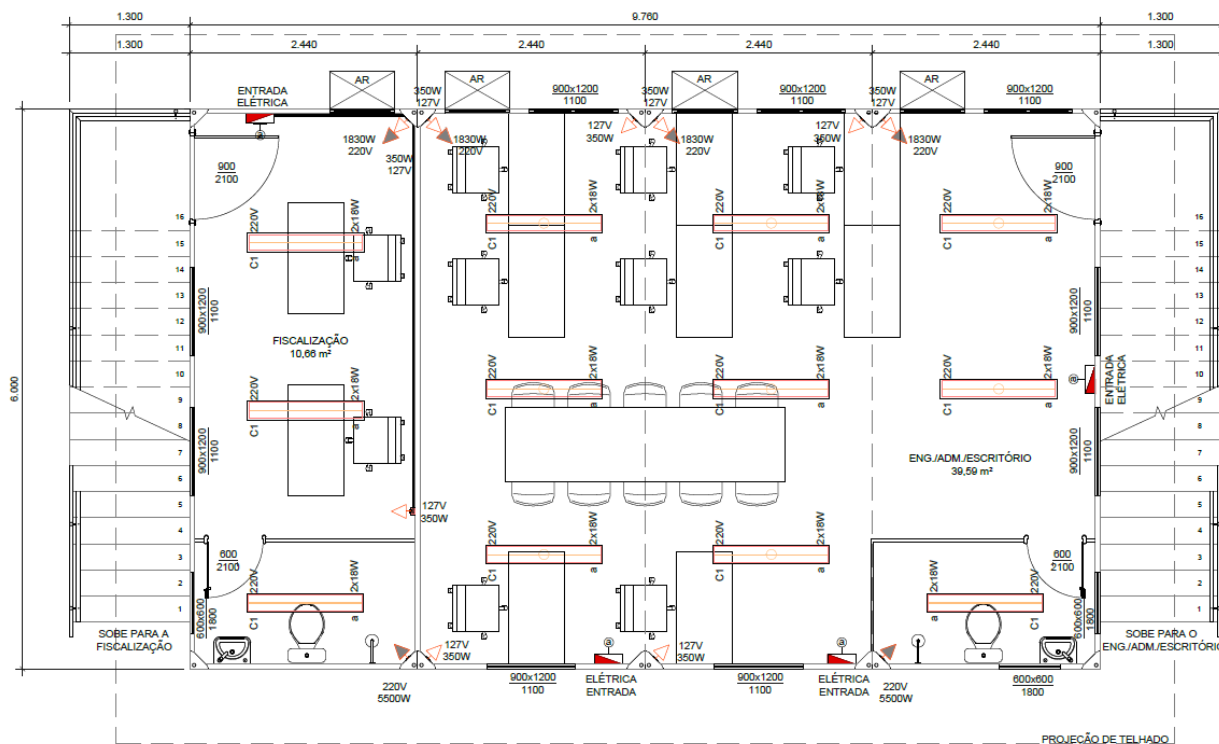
Planta 1º Pavimento: Fiscalização, Escritório, Engenharia e ADM.
